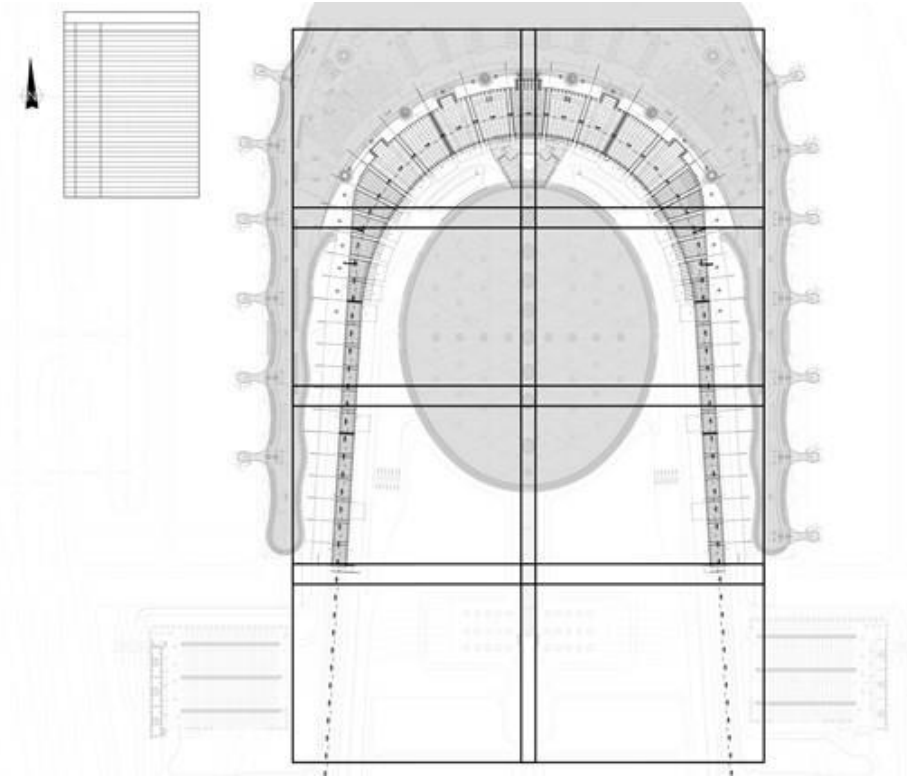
Planta del viaducto de acceso y de las estructuras cercanas (información proporcionada por Parsons).
